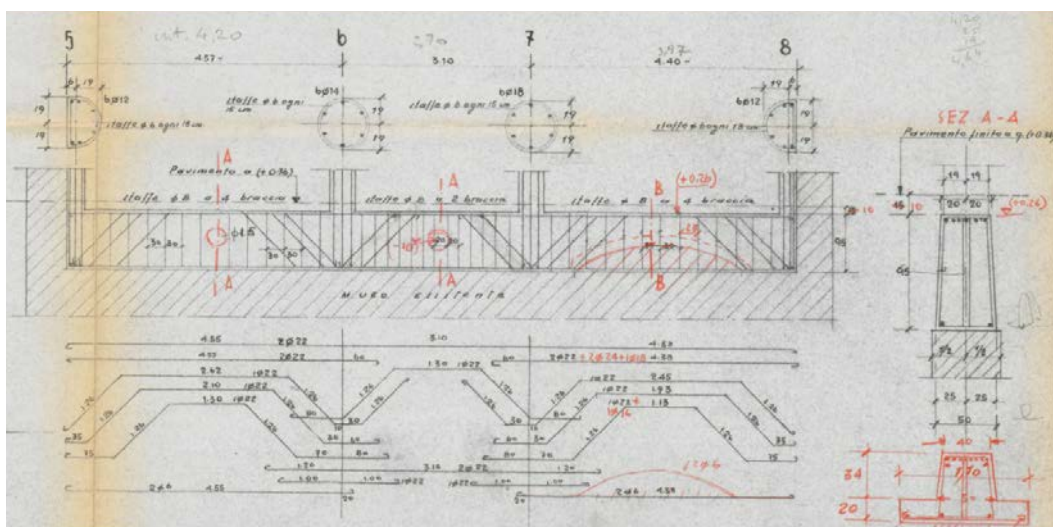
Estratto tavola fondazioni, dettaglio trave di fondazione (1960) - (Archivio del Comune di Padova)
